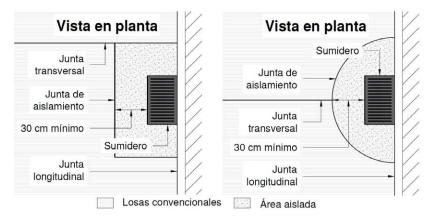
Esquema constructivo de juntas de aislamiento para sumidero Fuente: Adaptado de la Guía básica de juntas para pavimentos de concreto.
